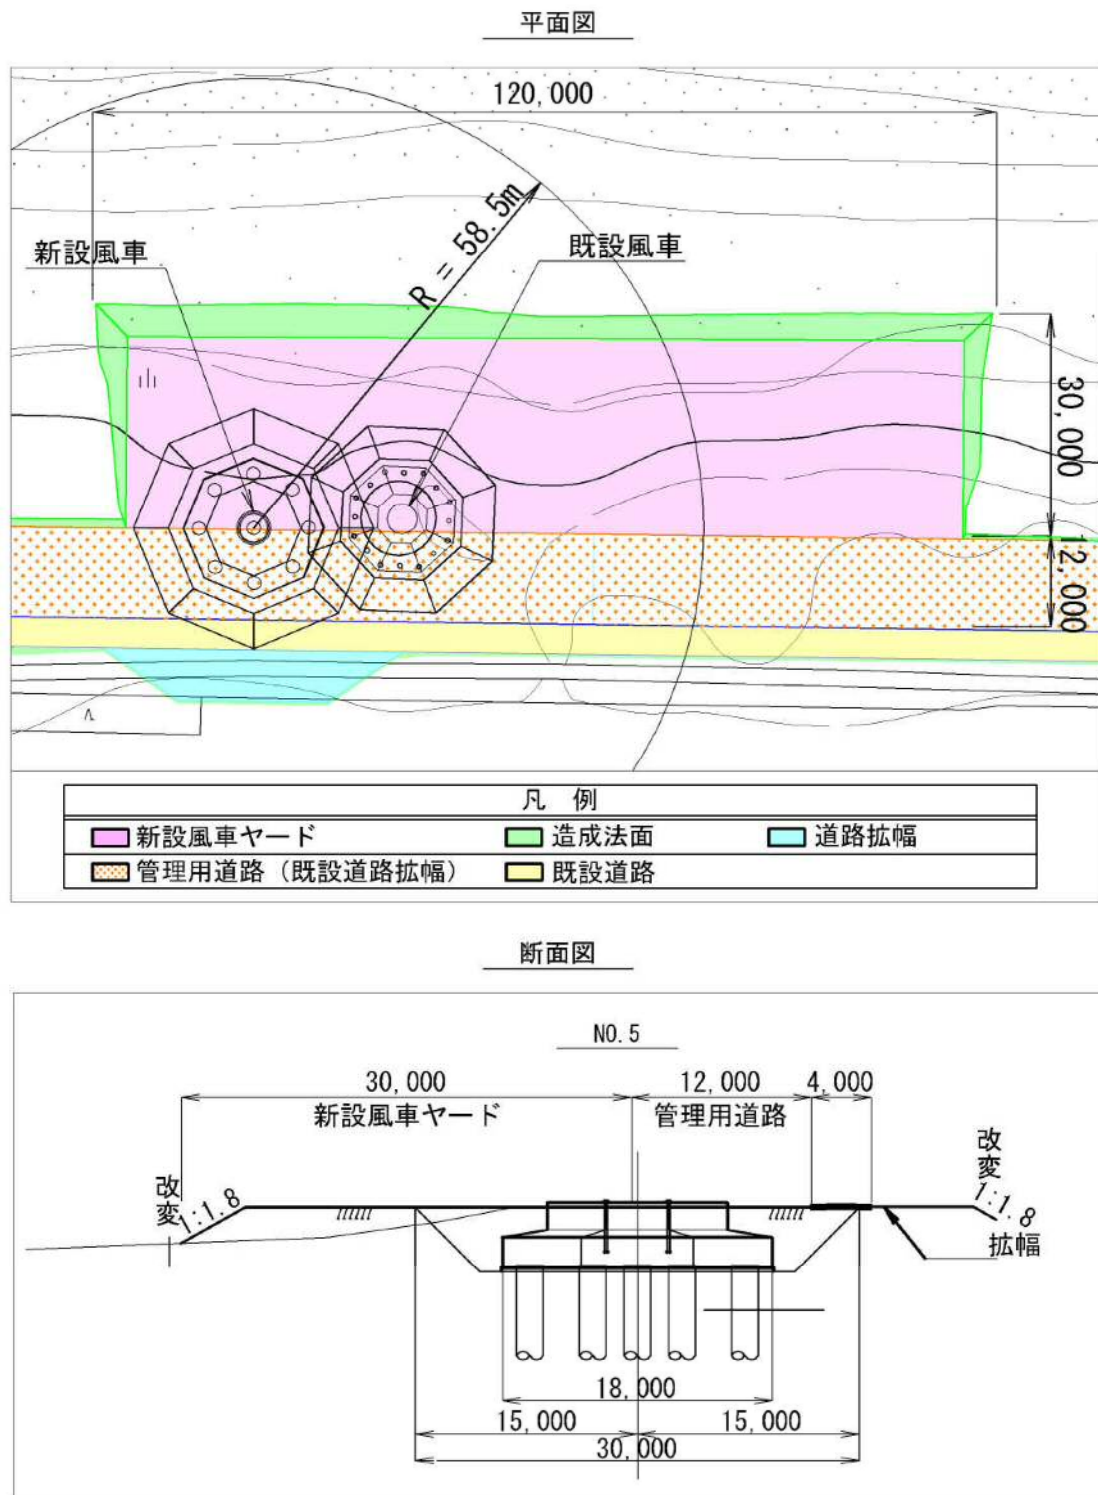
(5) 造成平面・横断計画図（新設 5 号機）
